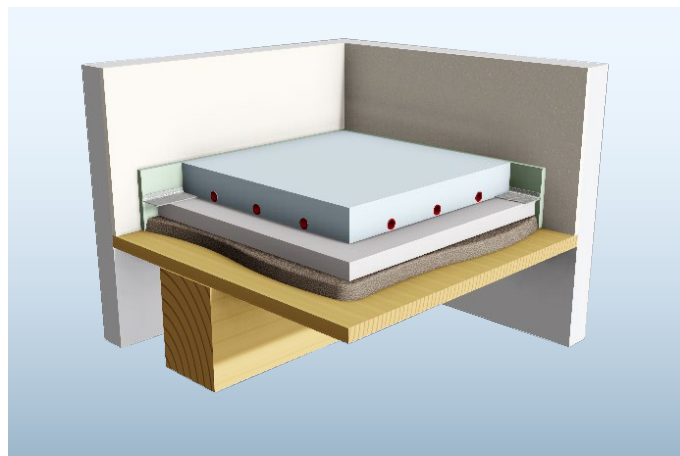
Chape sur un plafond de poutres en bois avec plancher chauffant
